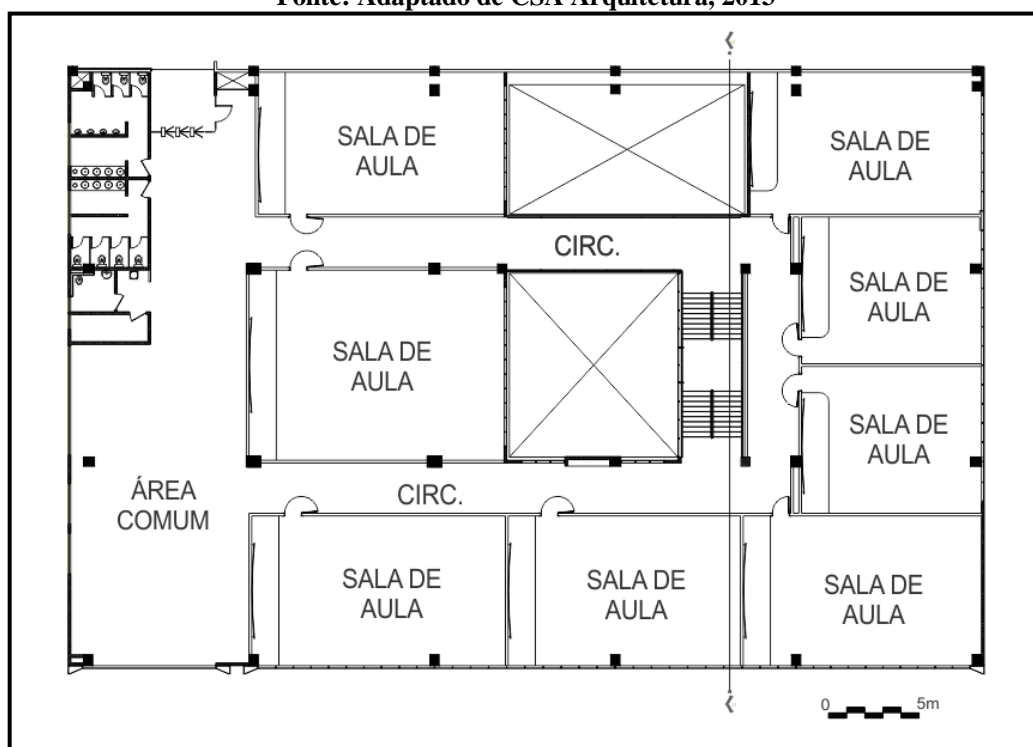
Planta baixa pavimento tipo - 2º ao 5º andar
